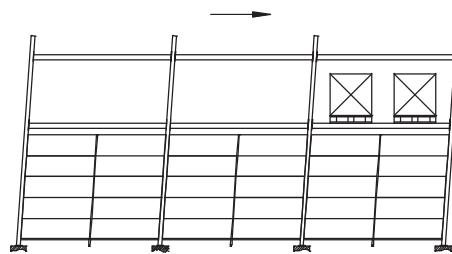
Стеллаж без перекрестных связей – возможность наклона
